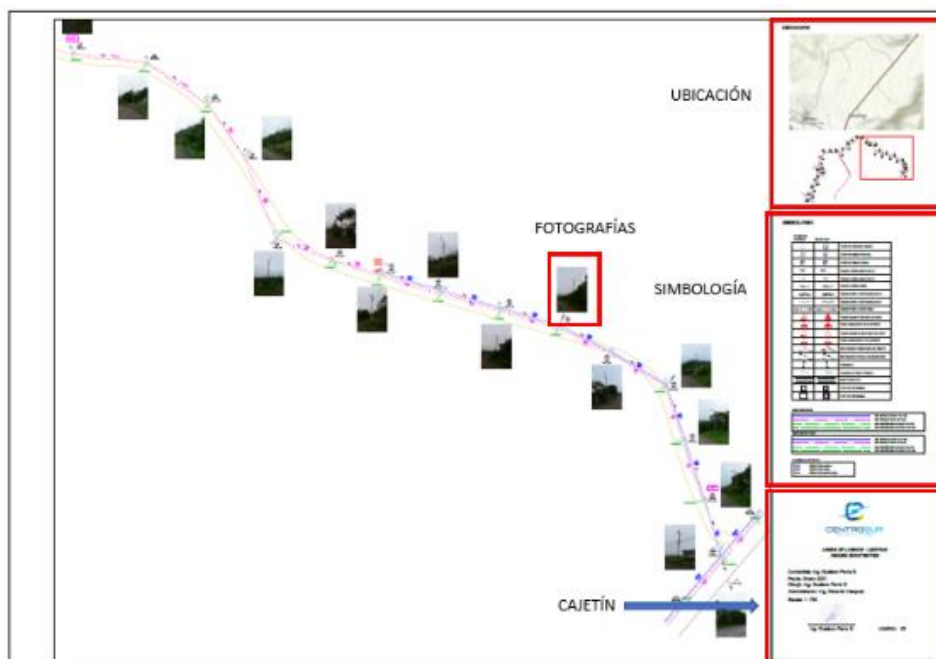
Distribución del plano existente del proyecto Lomon – Lentag.
